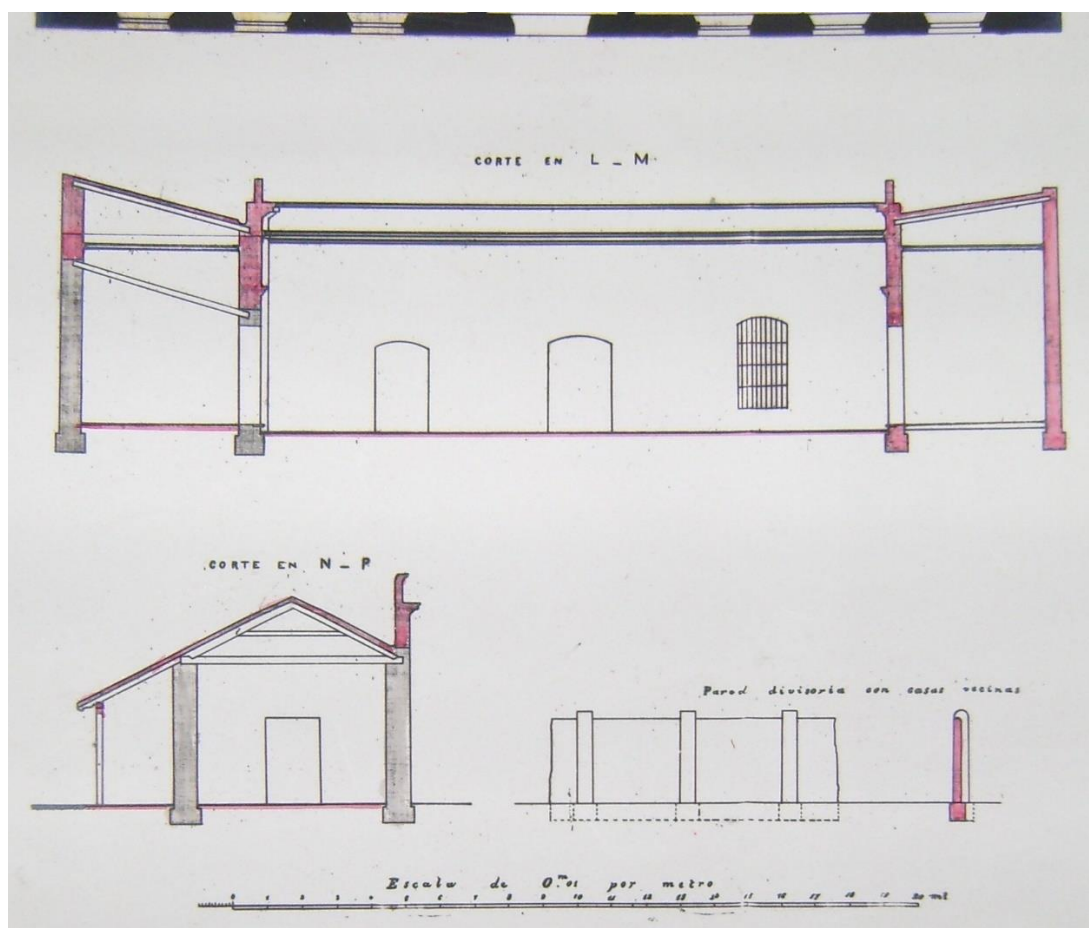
Detalle Cortes – Vistas plano nº 5 DGA
